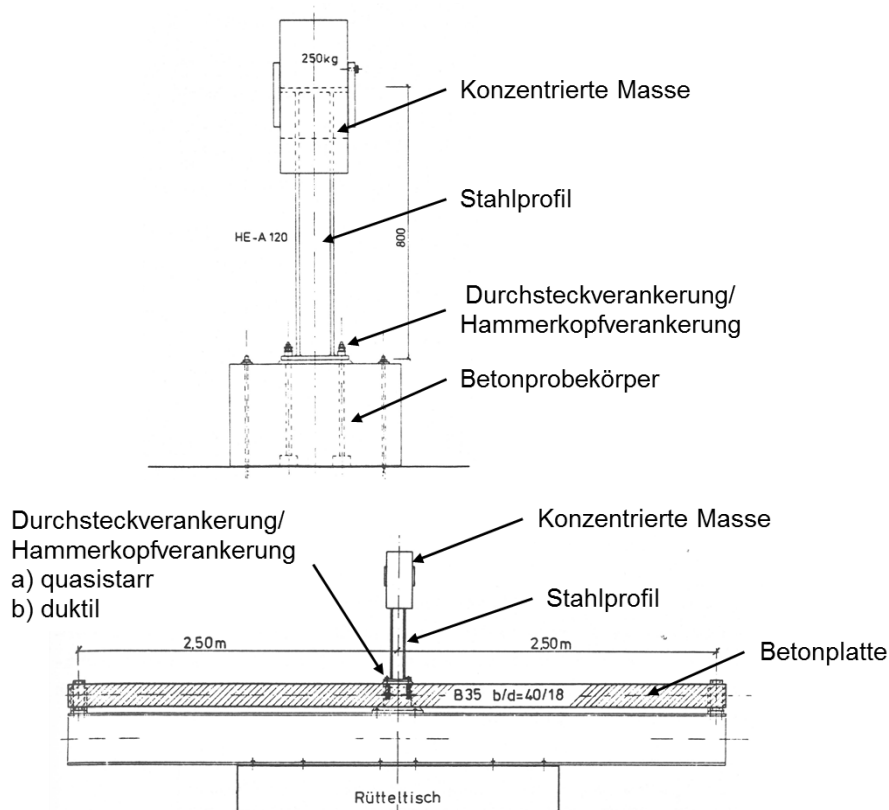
Versuchsstände zur Untersuchung des gekoppelten Systems Betonbauteil-Befestigung-Komponente bei Erdbeben [Wör1985]
